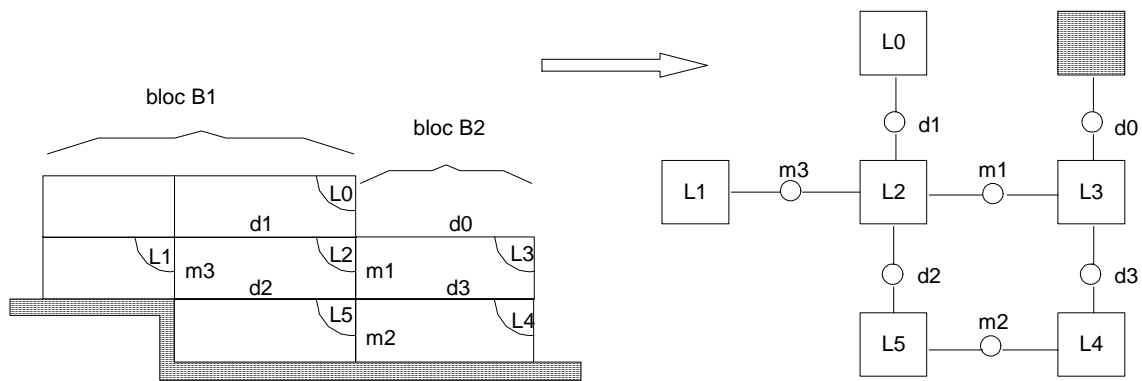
Coupe verticale pour fusion complexe dans le plan horizontal
